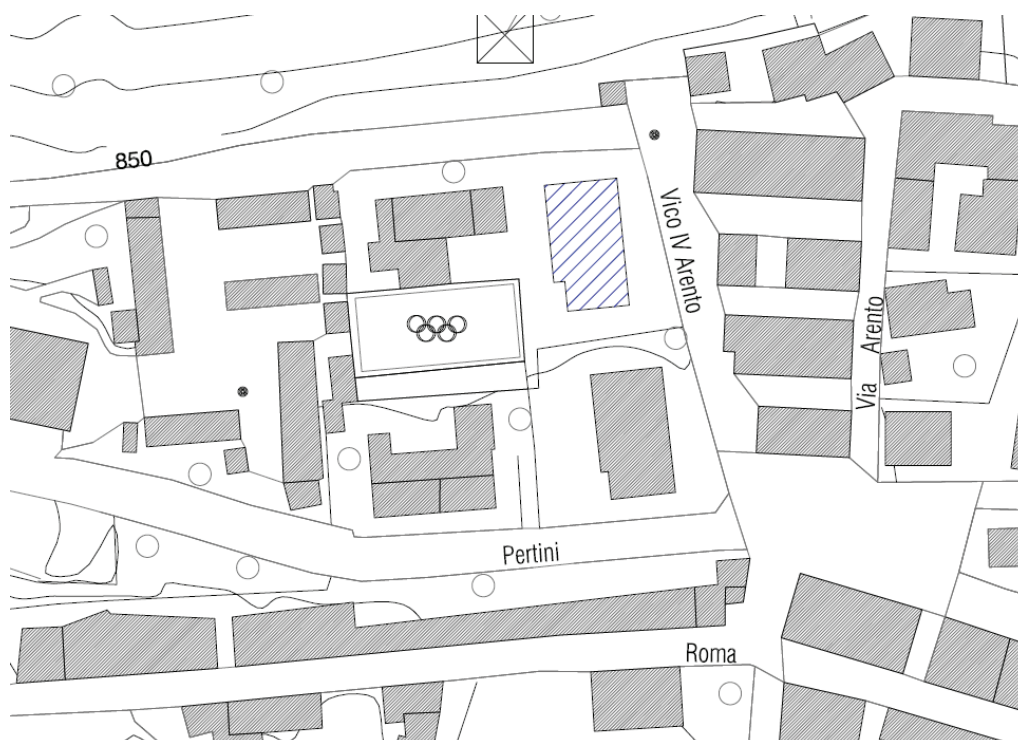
Planimetria generale dell'Intero Plesso Scolastico
